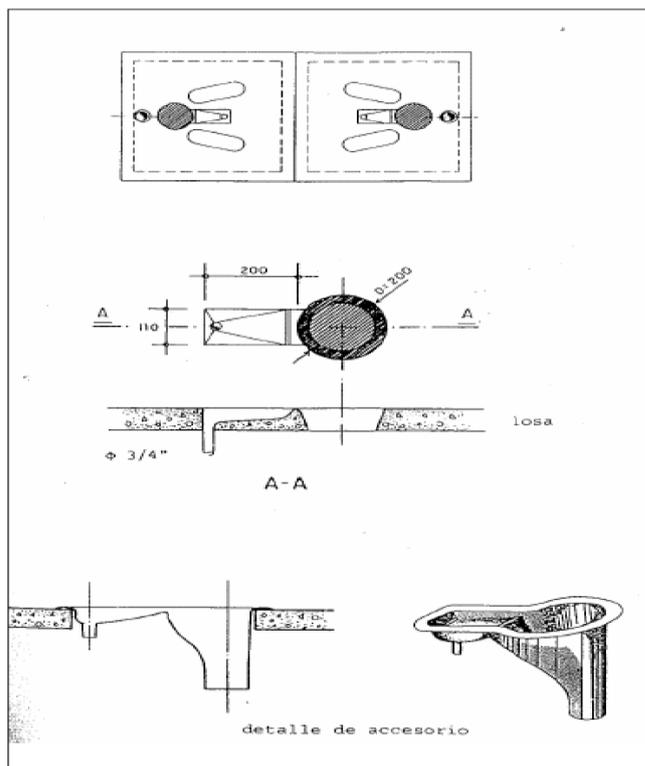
Detalle de losa turca y aparato sanitario para UBS Compostera
